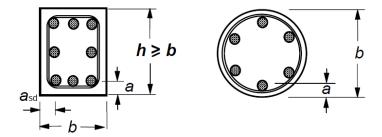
Sezioni degli elementi strutturali e distanza dall'asse a (UNI EN 1992-1-2:2005)
